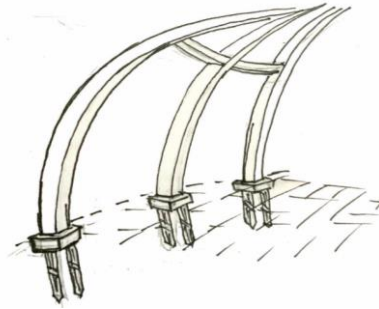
Struktur Pondasi Tiang Pancang dan Telapak
